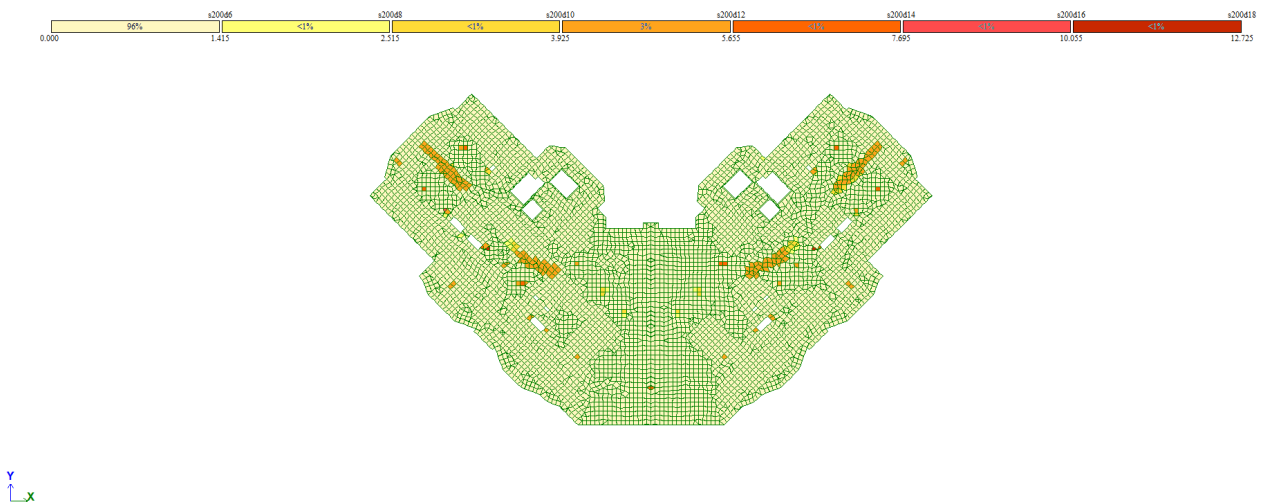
Площа арматури плити на 1 м. п. по осі x (нижня грань)
